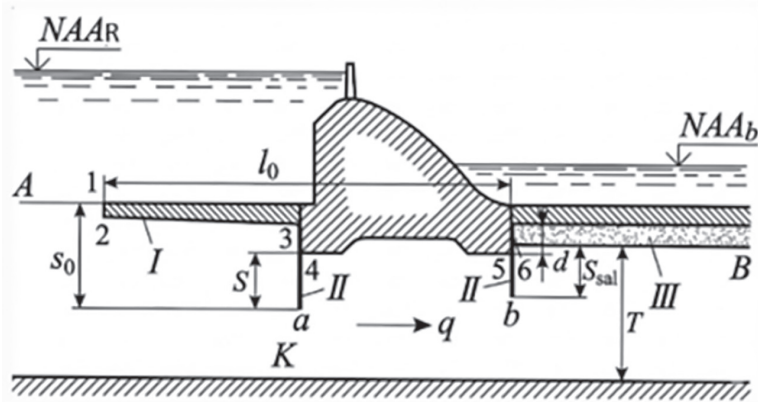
Carpeta y presa sin drenaje horizontal (esquema A).
